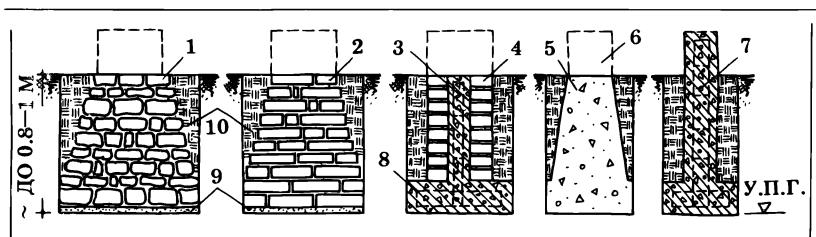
Столбчатые и ленточные фундаменты, устраиваемые в мелкопромерзающих пучинистых грунтах с расположением грунтовых вод в момент производства работ ниже подошвы фундаментов
